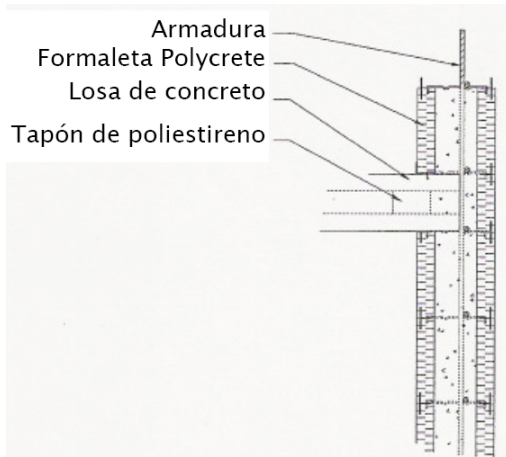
a. Soporte de una losa de concreto vaciada sobre un muro Polycrete®
